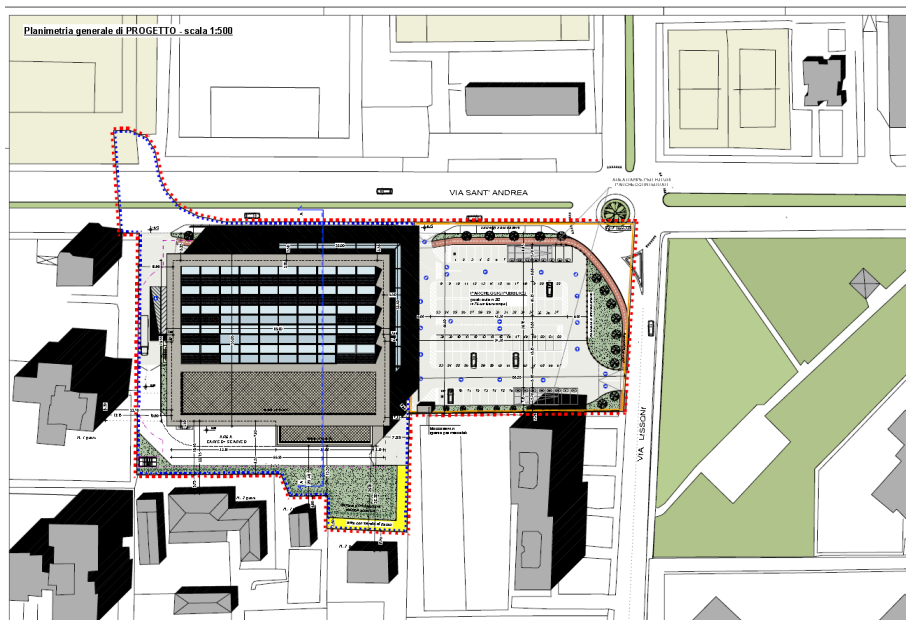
Planimetria intervento P.A. ex Cinema Maestoso
